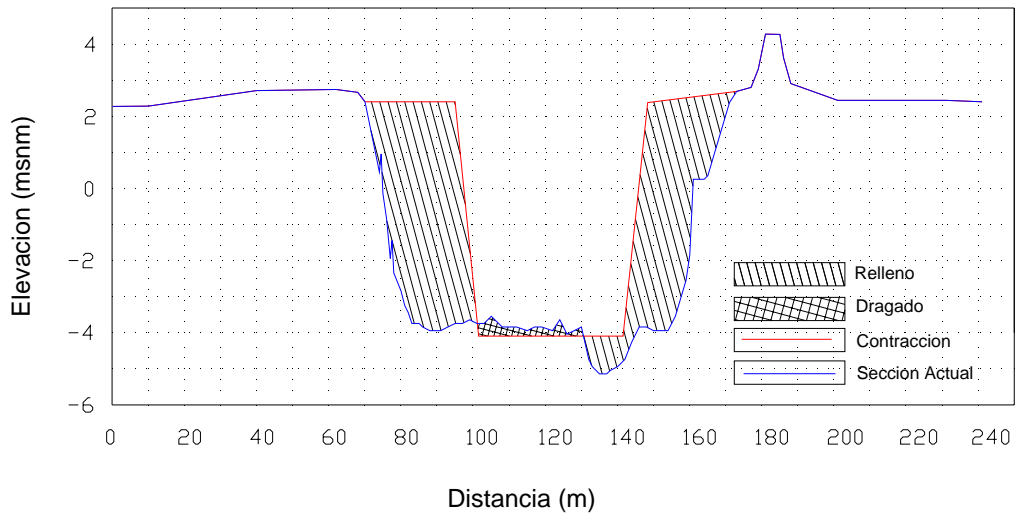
Sección transversal km 73 - Contracción No. 3
